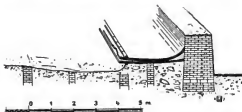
Schnitt durch Fassade und Traufestrich. Unter dem Estrich die Vorderwand eines Fundamentkastens; davor die Reste eines älteren Bauwerks.
